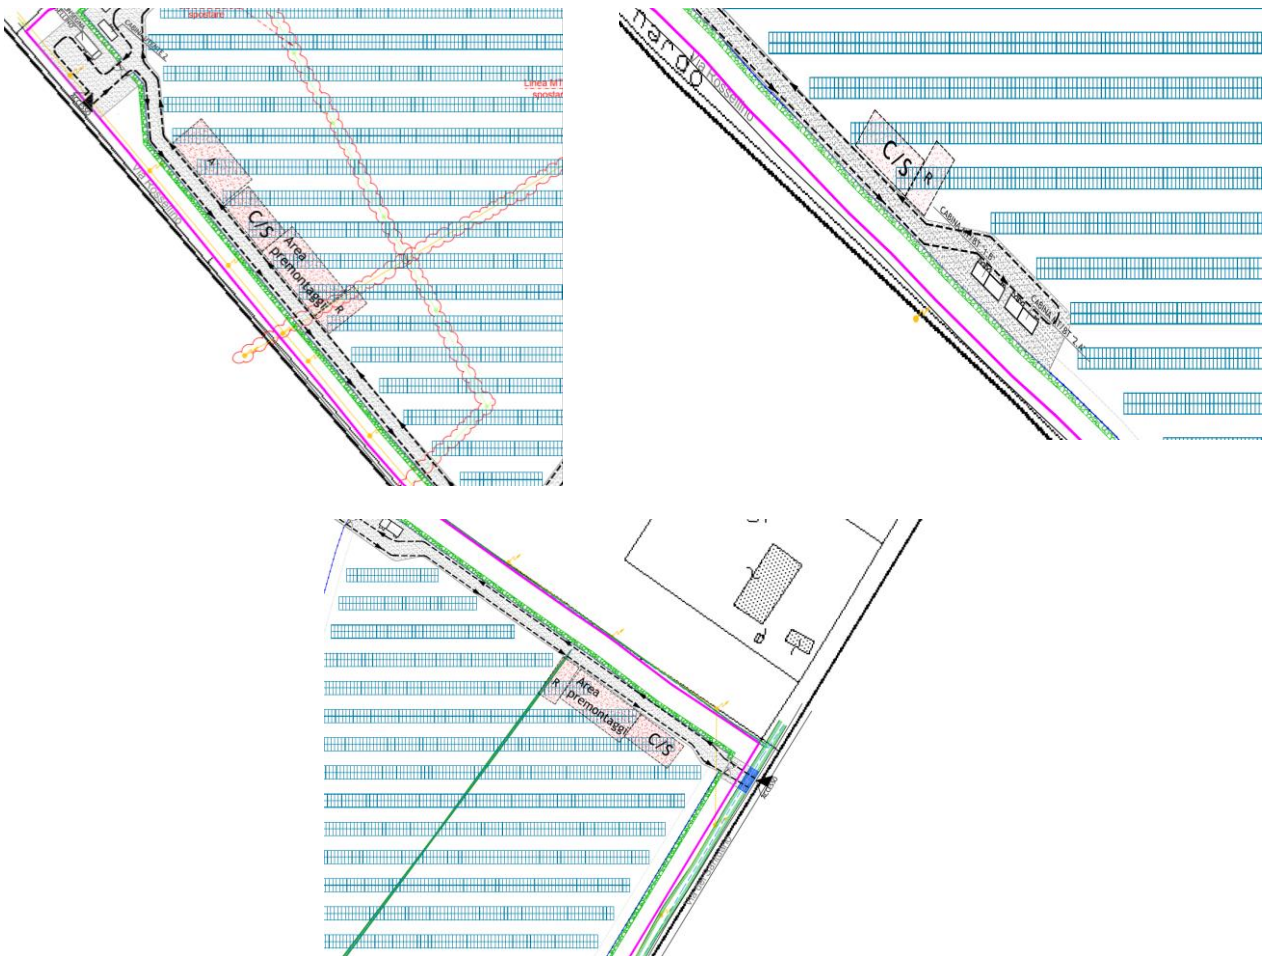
dettaglio area di cantiere impianto “FORLI’ 1-2”
